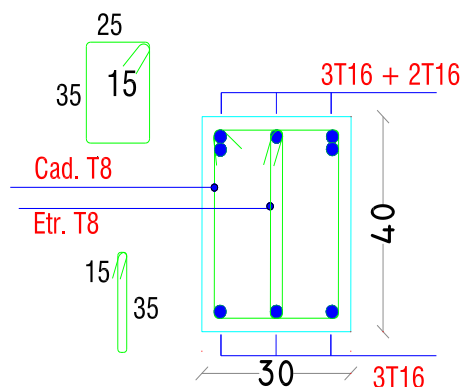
Ferrailage des poutres principales pour Etage 9.
